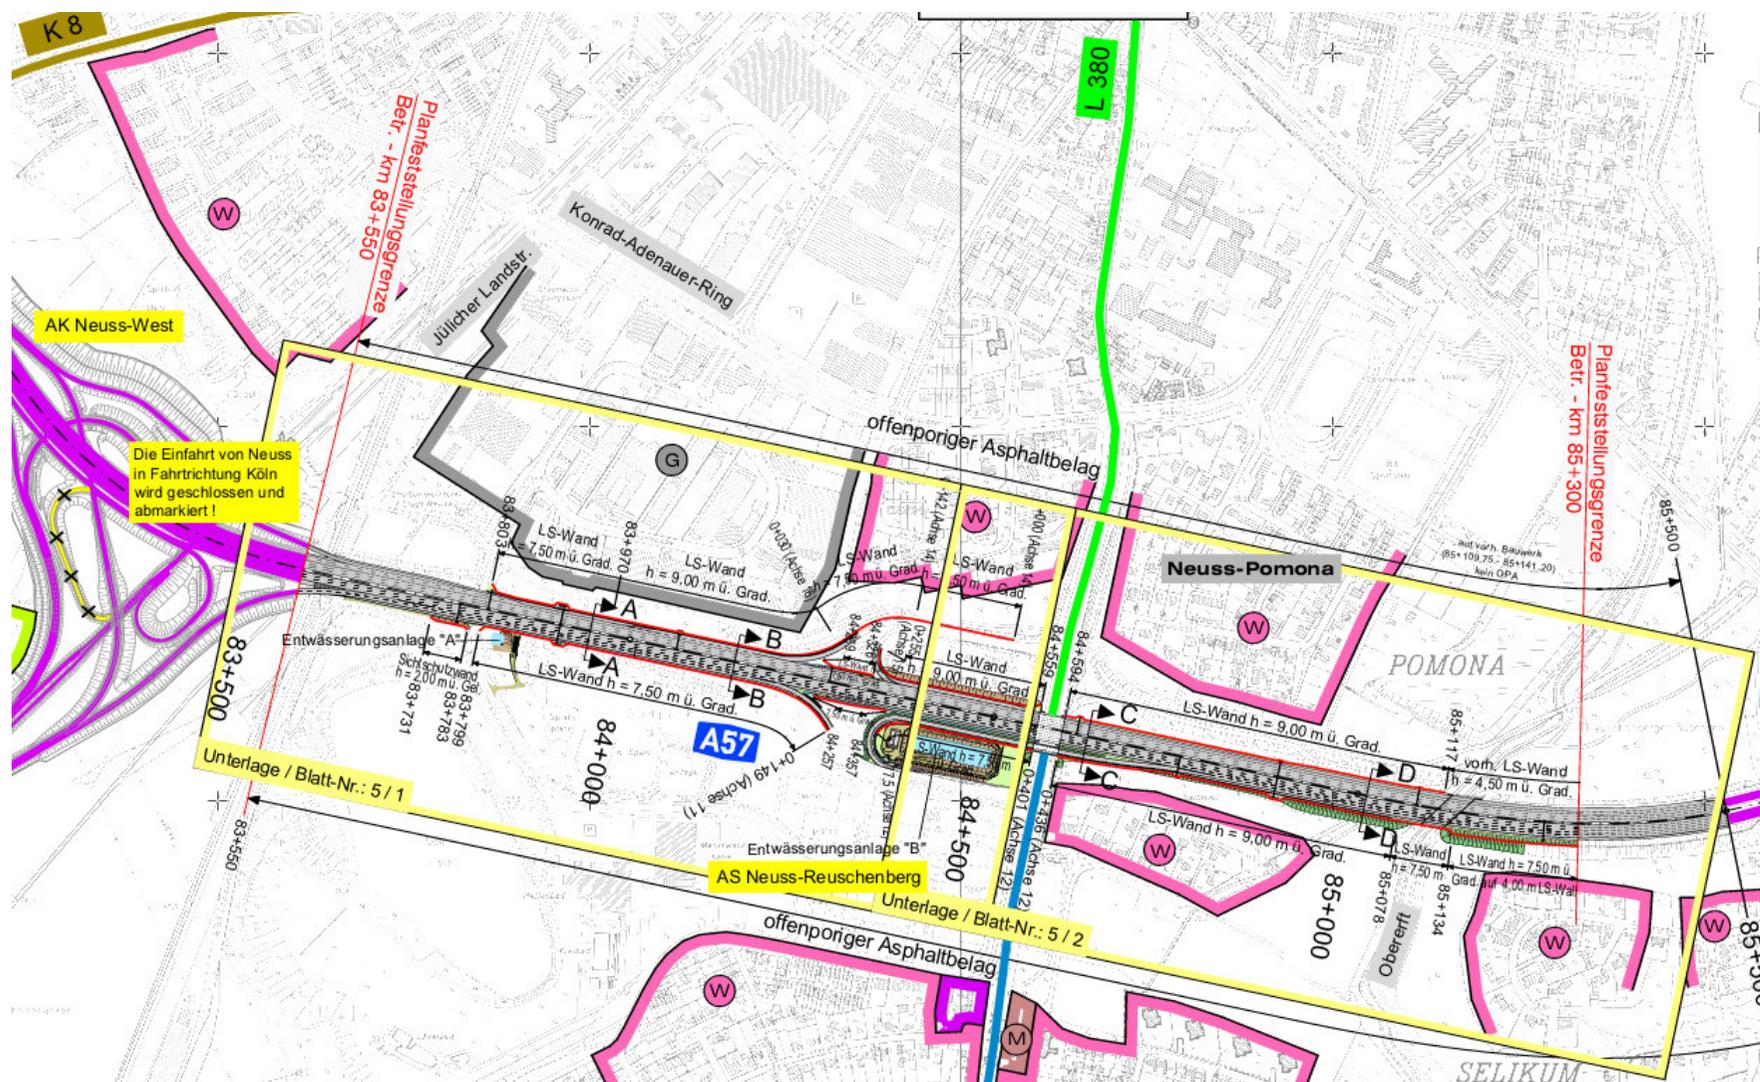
Ausschnitt des Übersichtslageplans (Planunterlagen: 03_01_Übersichtslageplan.pdf)
